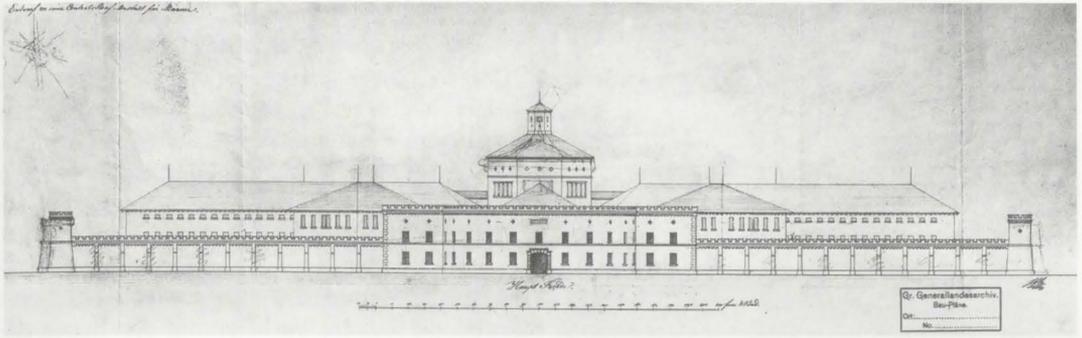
Erster Entwurf, bez. „Entwurf zu einer Central-Straf-Anstalt für Männer./ Haupt Facade.“, sign. „Hh“. GLA, G Bruchsal 30. Photo GLA
